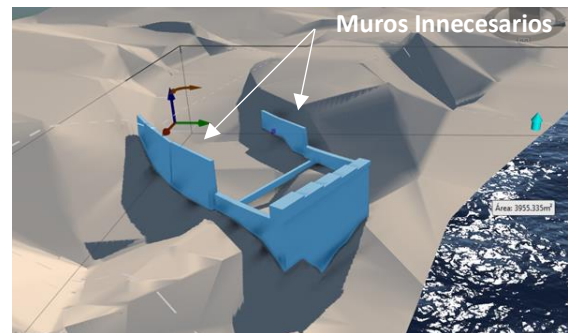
Evaluación de necesidad de construcción de muros en el estribo izquierdo
